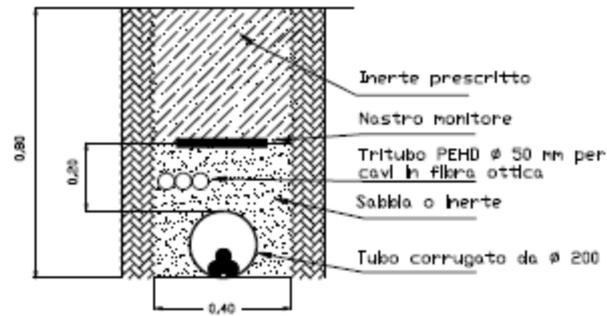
Sezione su strada sterrata o terreno agricolo - posa di n°1 cavi MT
